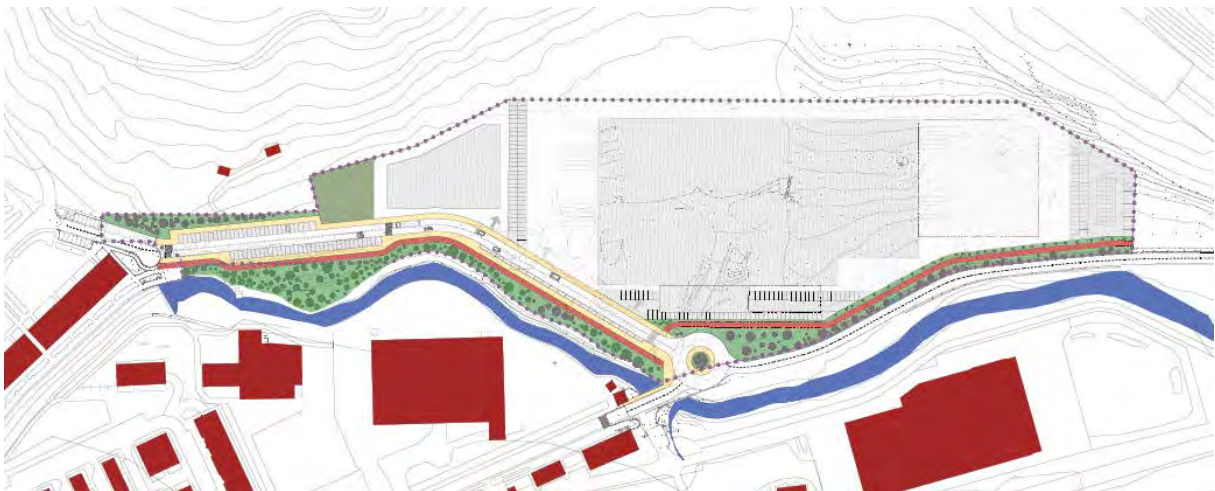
Ordenación pormenorizada propuesta en el sector S-1b. Fuente: Plano 04 'Ordenación' del Plan Parcial.
